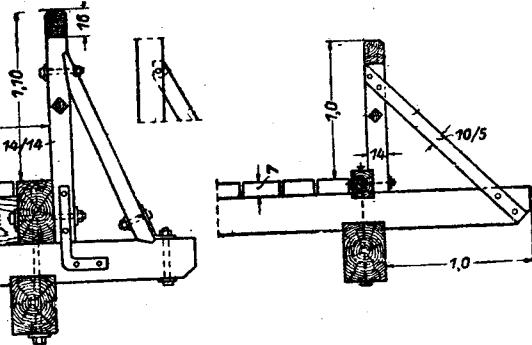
茂森橋側徑間の高ラン Fig.8 Railing of Shigen ori br.
